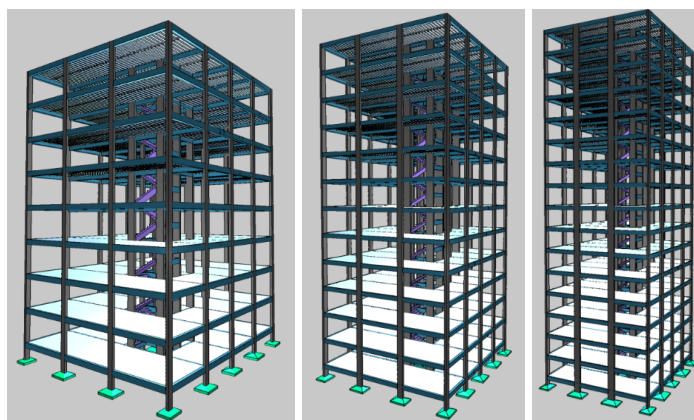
Modelos tridimensionais com 8, 12 e 16 pavimentos, respectivamente.
